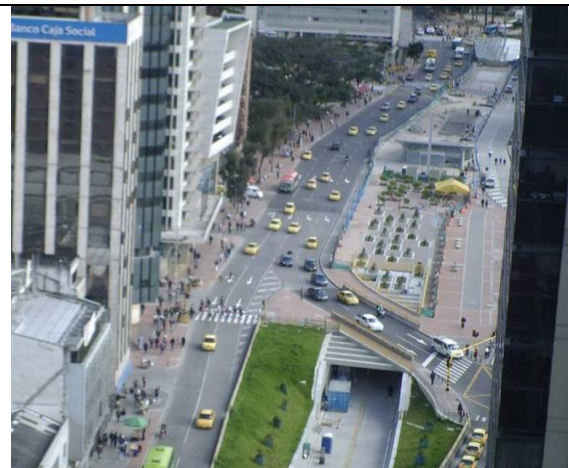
Carreras 7 con Calle 30A: Final pavimentos afectados por Estación Museo Nacional.
